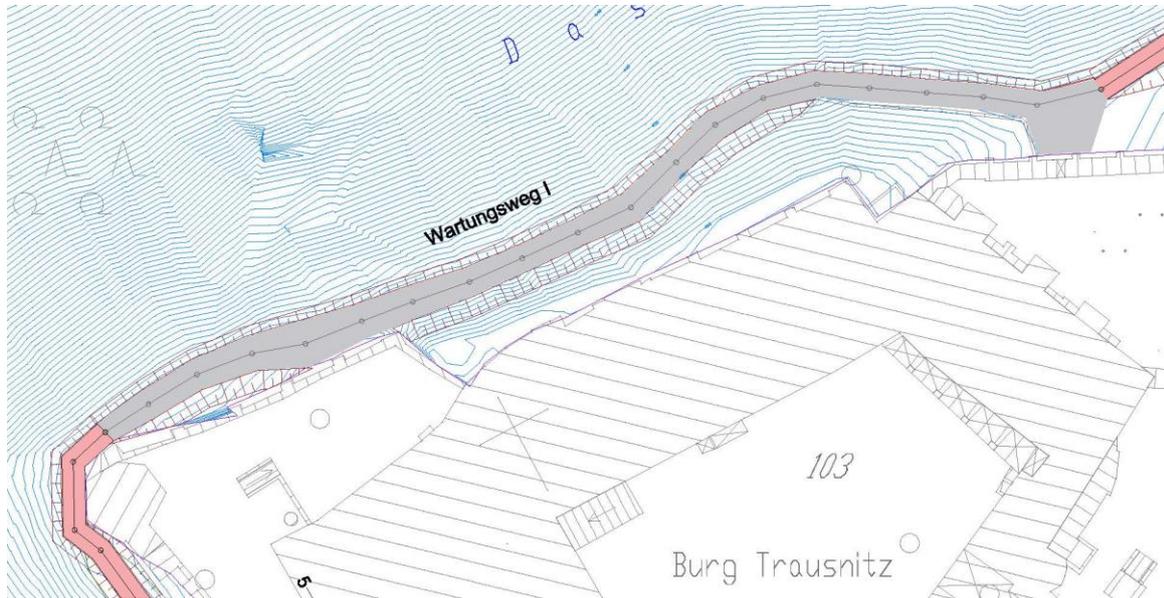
Lageplan Bereits fertiggestellter Wartungsweg Abschnitt I
